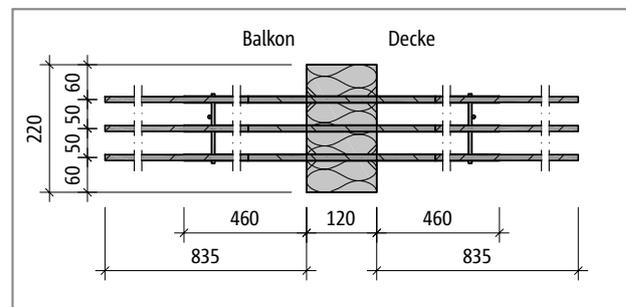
Schöck Isokorb® Typ SXT1-VB2: Produktgrundriss
